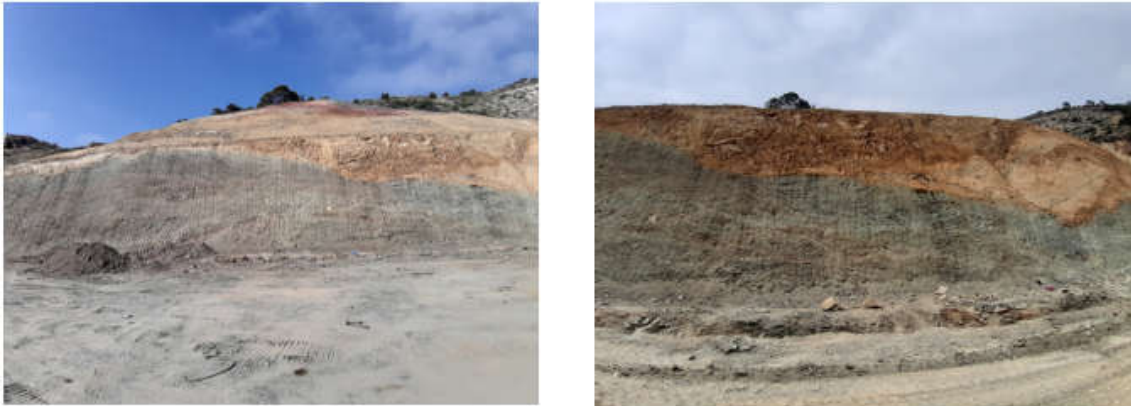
Photographies de la section PK0+100-PK0+180
